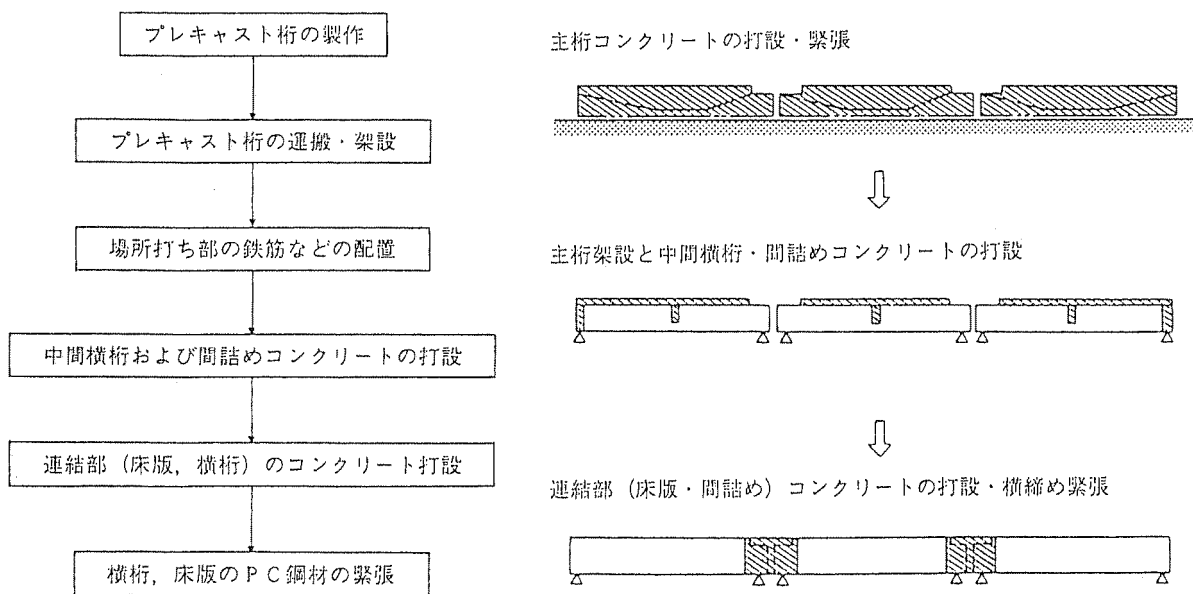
RC 連結方式の T 桁橋の施工手順の例
